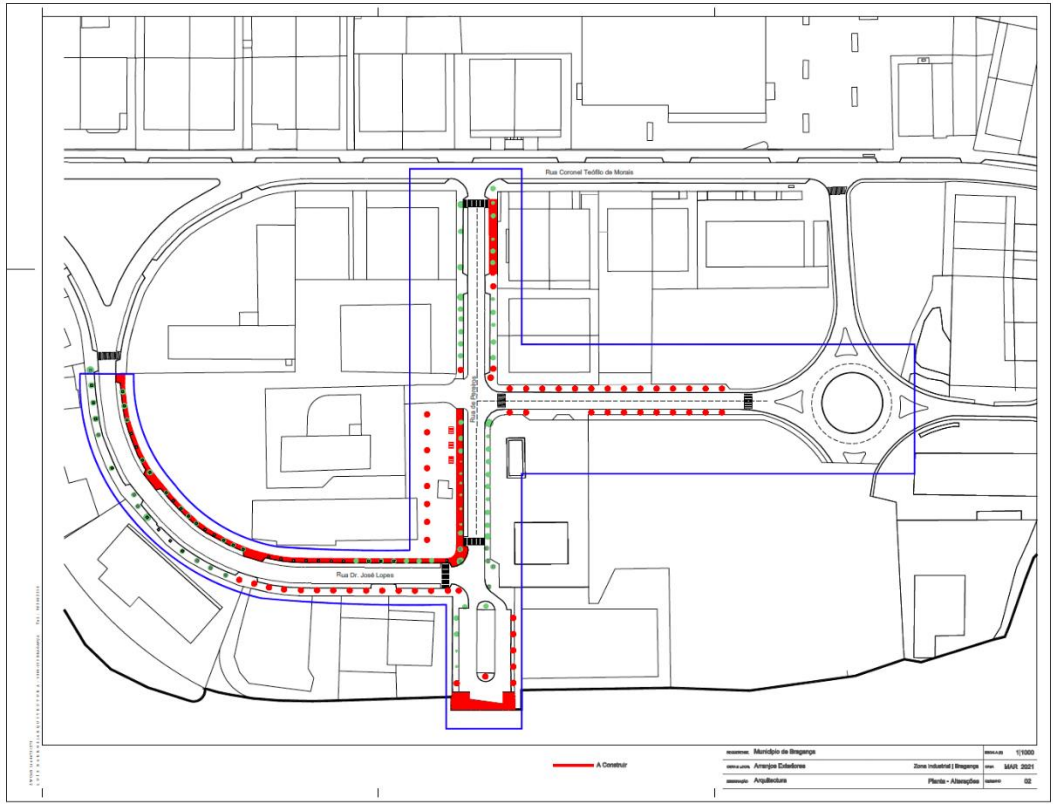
Planta de modificaciones (elementos existentes y a construir). Fuente: Luis M. Cordeiro de Barros.
